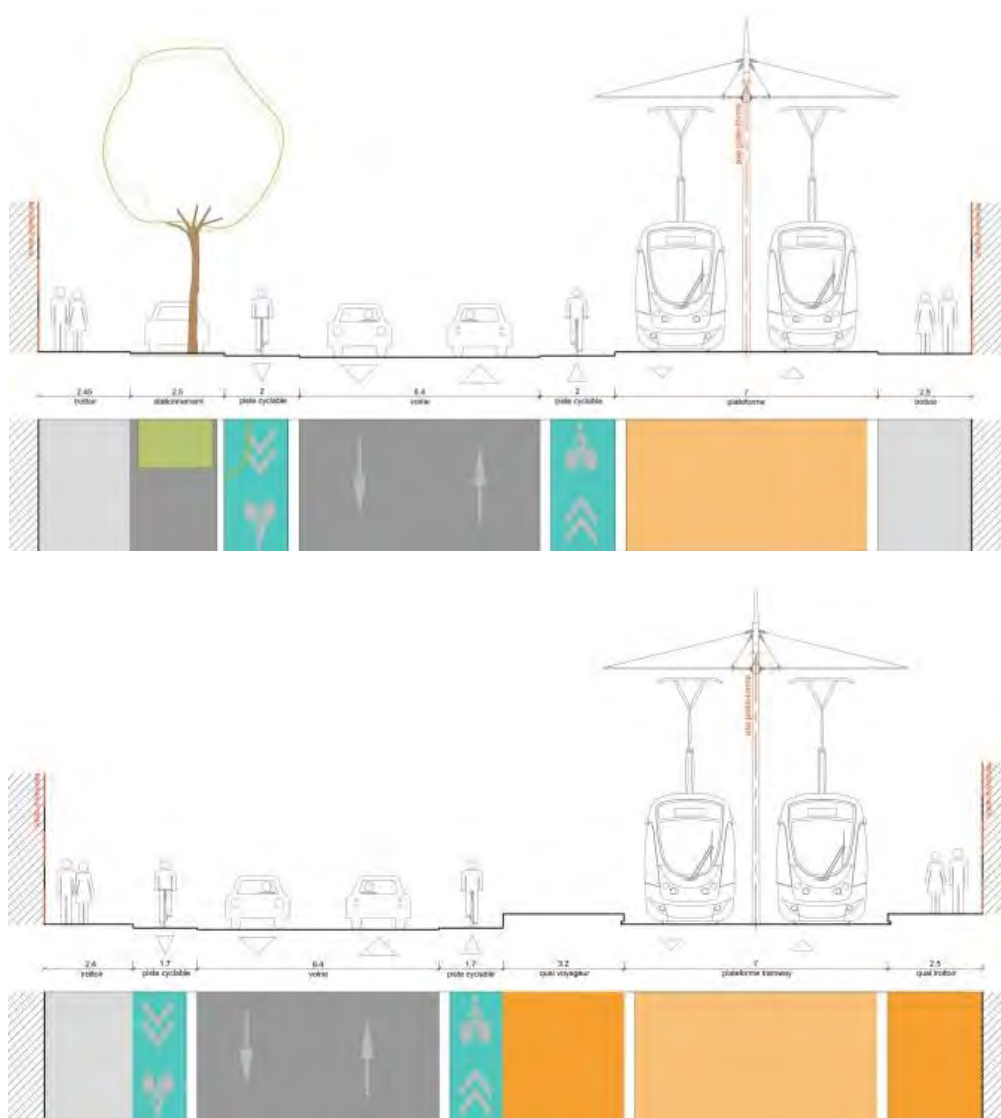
Tramway – insertion latérale de la plateforme – section courante et en station
